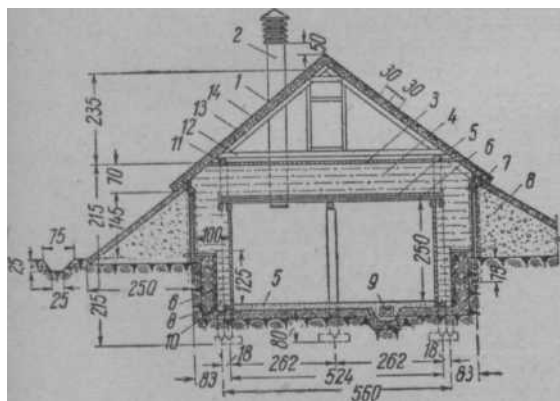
Типовой полуподземный зимовник: 1 — глиносоломенная кровля; 2 — верхний вытяжной канал; 3 — слой сухой земли; 4 — утепляющий слой соломенной резки с хвоей; 5 — песок; 6 — пластины; 7 — глиноплетчатая стена; 8 — глина; 9 — приточный канал; 10 — соломенная резка с песком; 11 — прогон; 12 — ригель; 13 — стропила; 14 — жердевая обрешетка (размеры в см).
